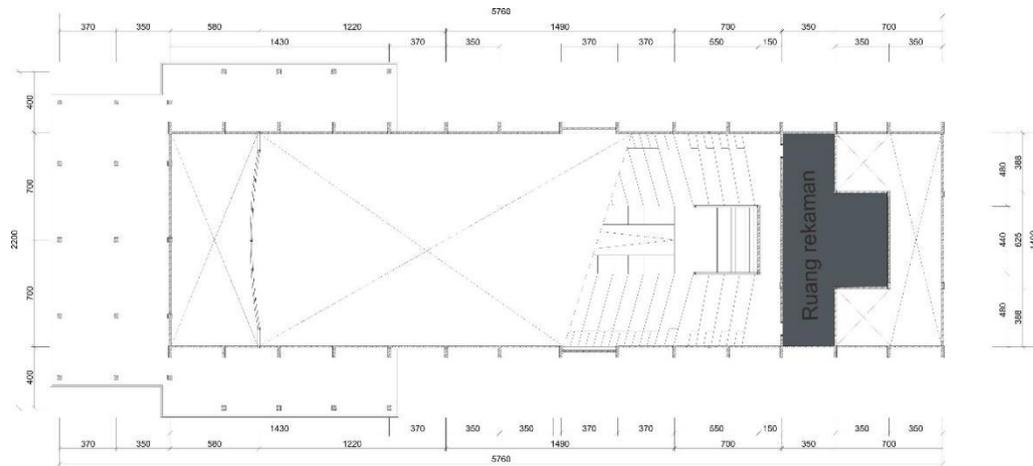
zoning dan sirkulasi lantai 2 alternatif 1
